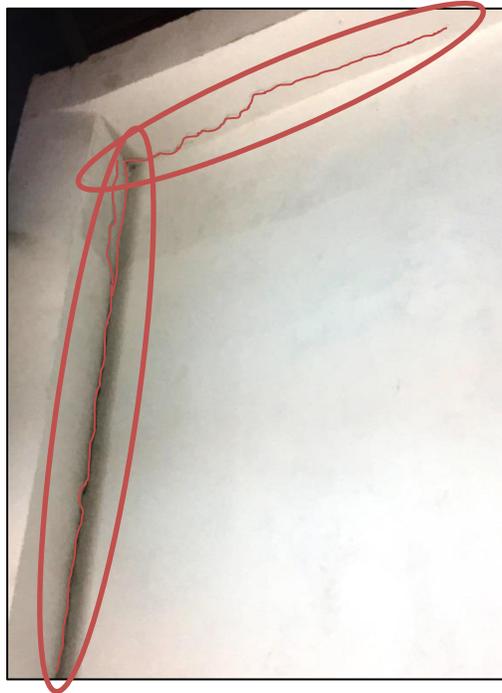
Muros fisurados en bloque B6 – Salones de artes plásticas
